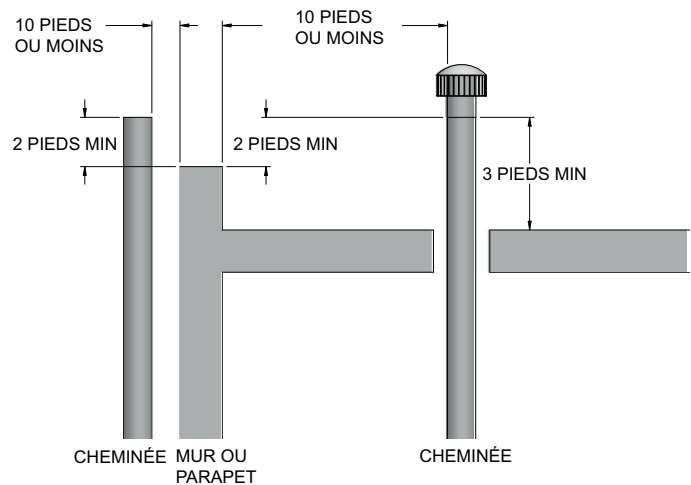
Terminaison de ventilation depuis un toit en terrasse 10 pieds ou moins du parapet
